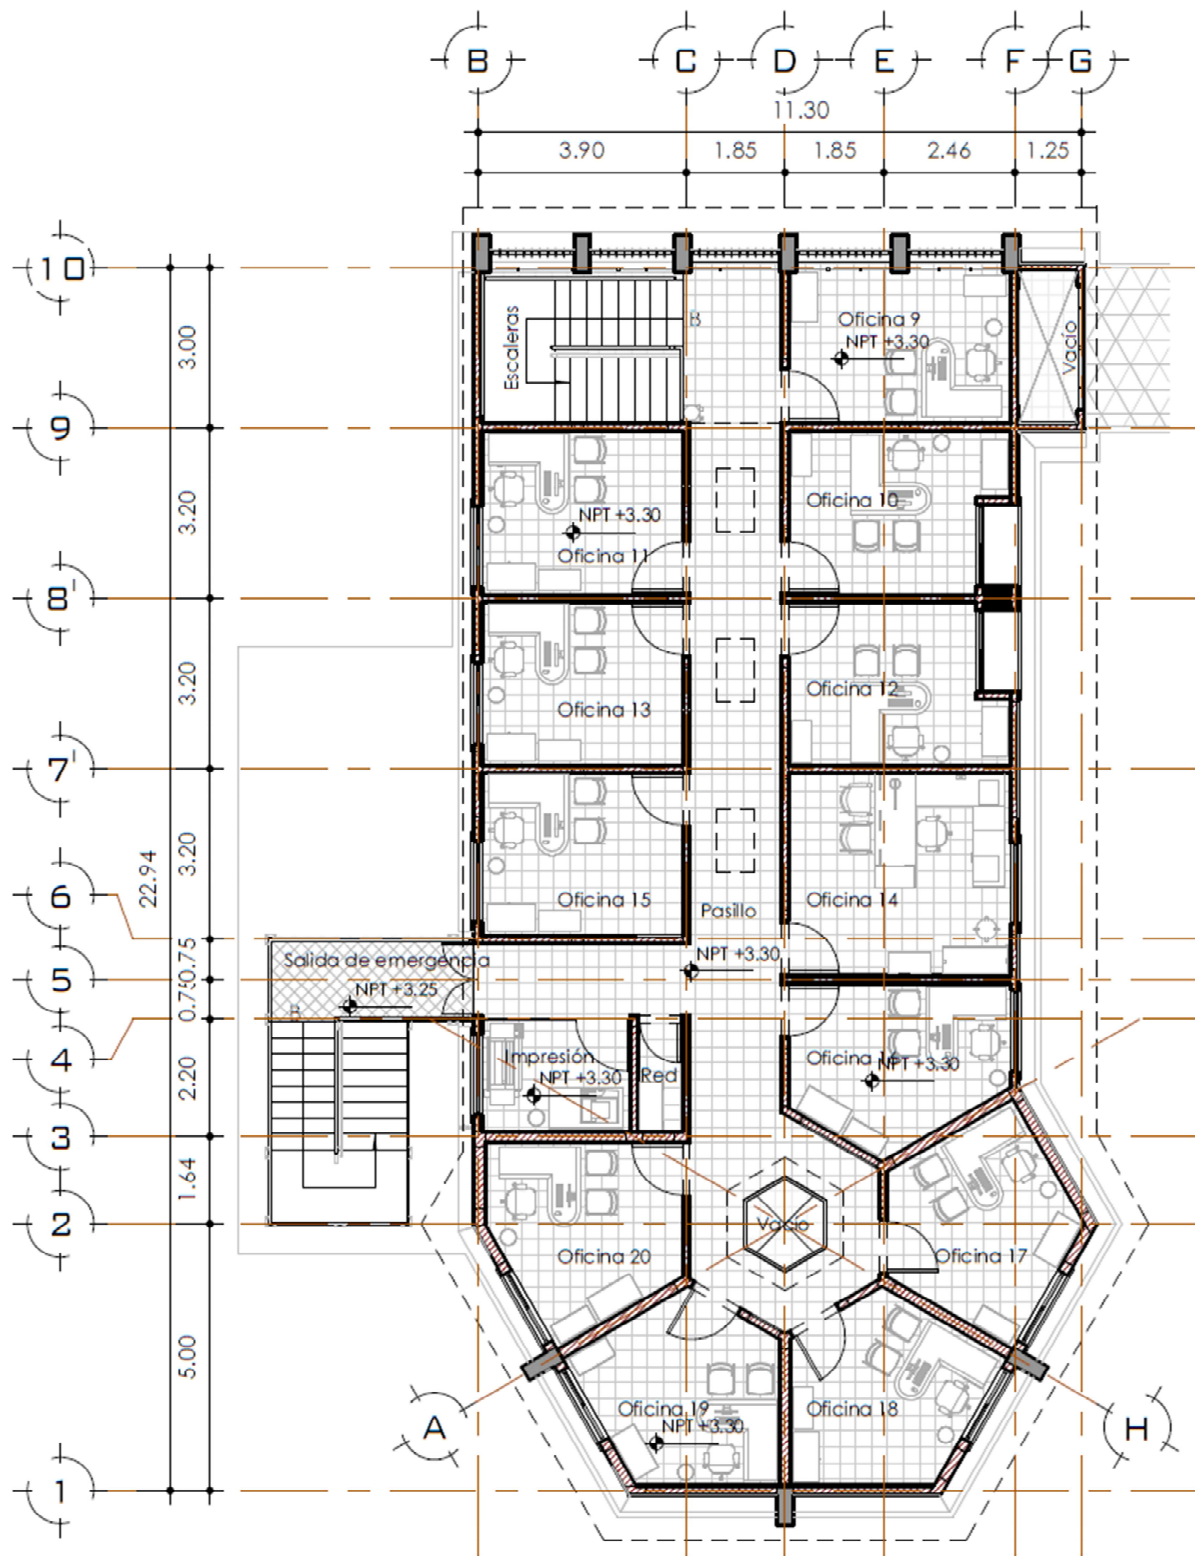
Planta arquitectónica alta (ver detalle en plano A-ARQ-02). Escala 1:125
